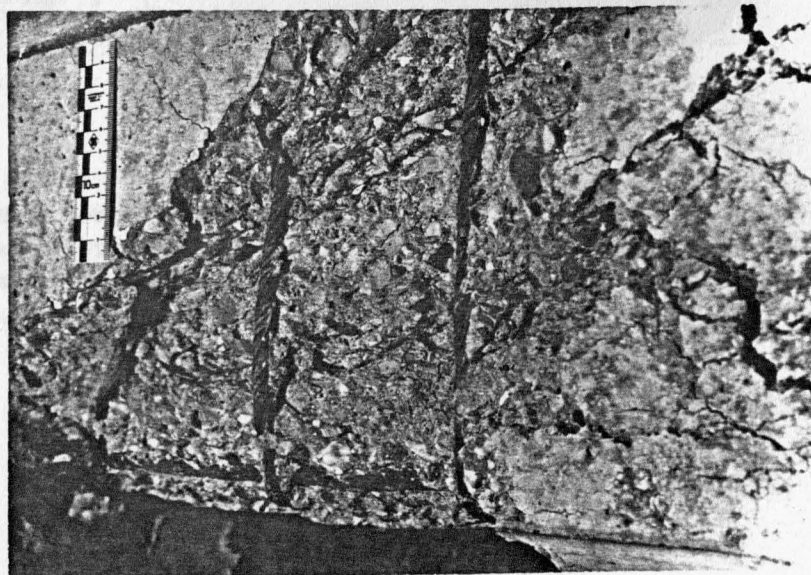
gerissene Bügel und Betonbruch in Richtung der Haupt-Druckspannungstrajektorien im Mittelauflegerbereich des Balkens 8
